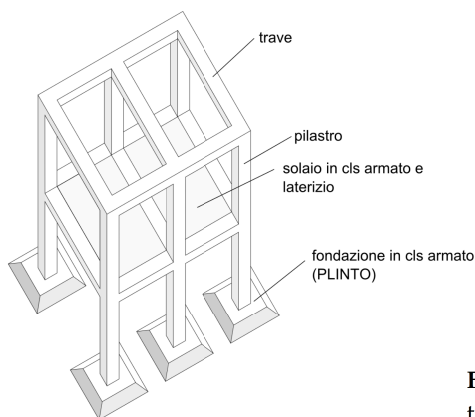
Ossatura strutturale in travi e pilastri in cls armato; travi e pilastri sono perfettamente collegate tra loro e sostengono i solai in cls armato e laterizio.
